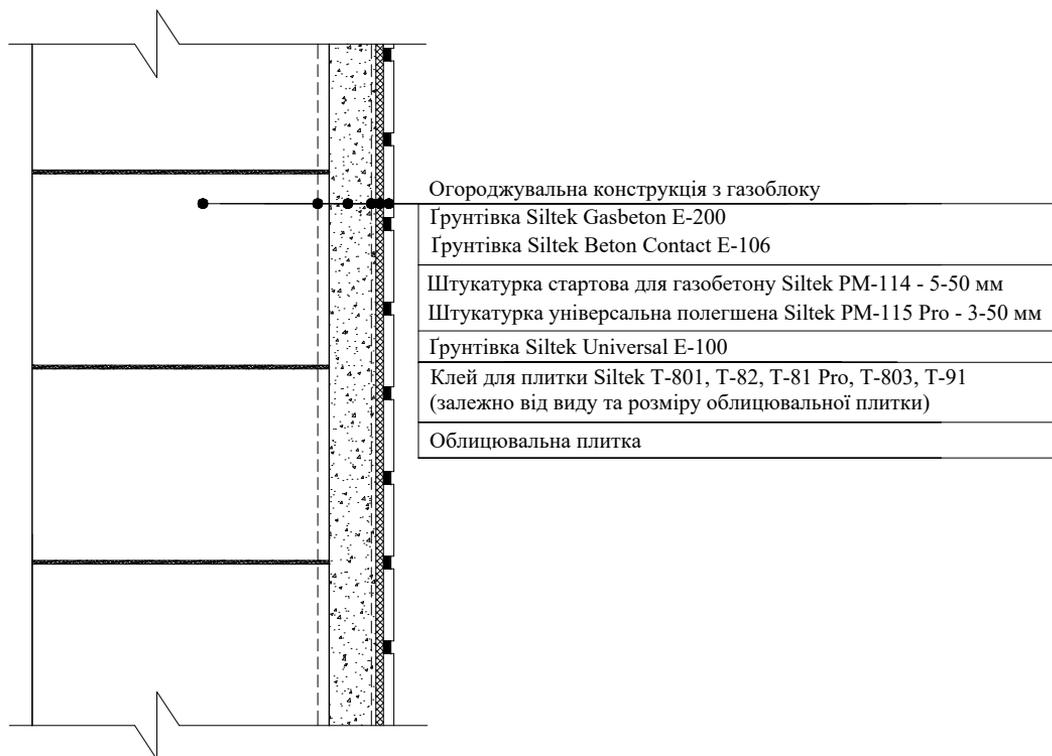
Схема облицювання стін плиткою без попереднього вирівнювання поверхні всередині та зовні будівель
